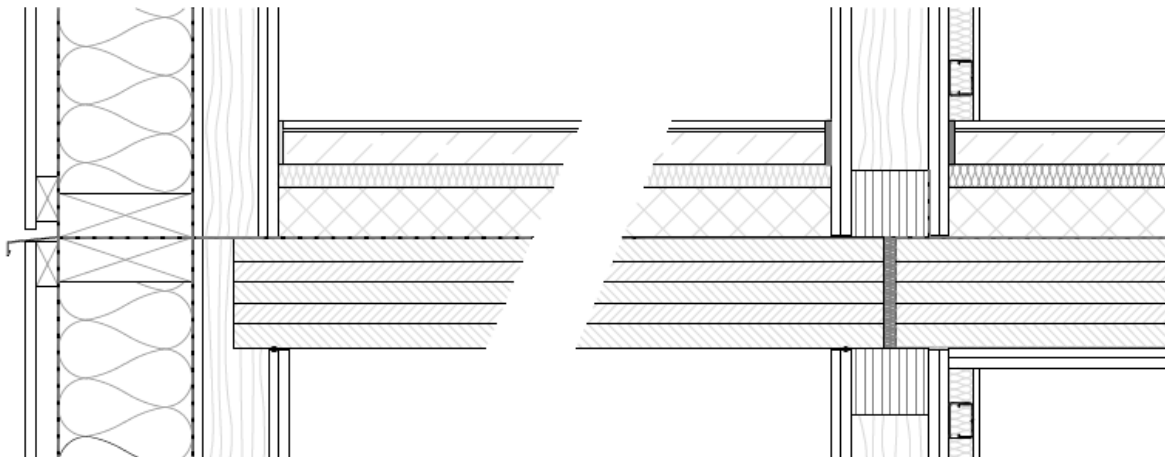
Anschlussdetail Außenwand und Wohnungstrennwand – Decke
